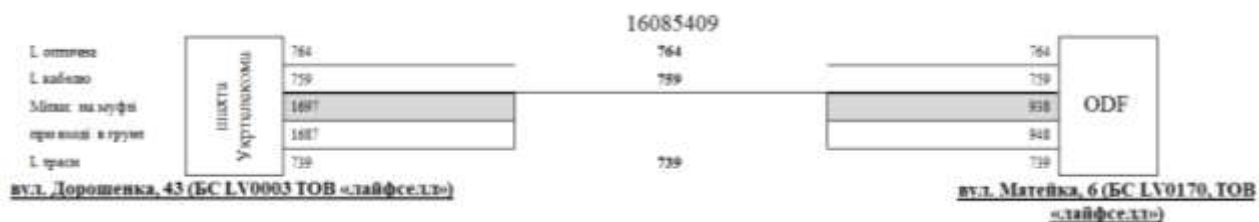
Схема монтажу муфт на будівельній ділянці
